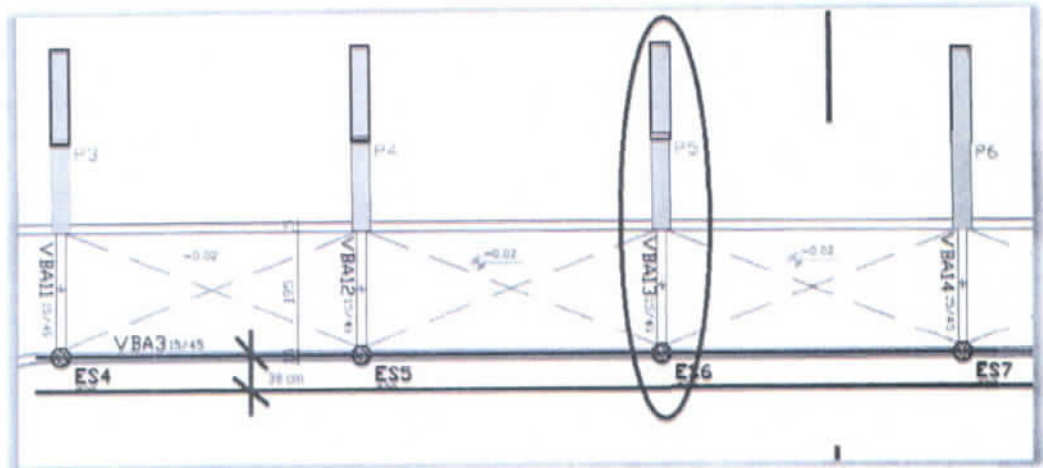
VIGA VBA 13 EM PLANTA APÓS DESLOCAMENTO DA ESTACA
